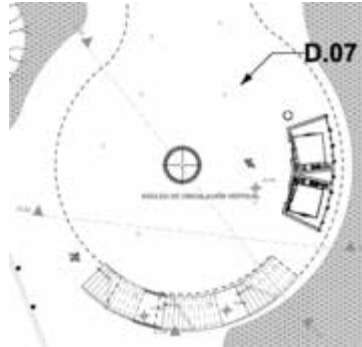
Plaza de acceso 3, planta baja. (+0.17m). (2017)
